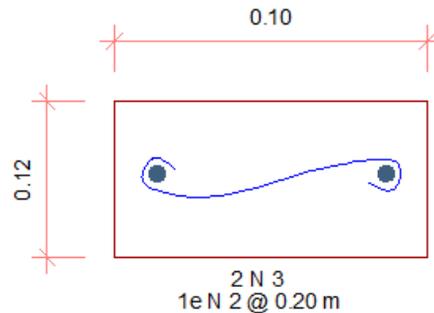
Detalle de viga de cimentación- concreto ciclópeo.
